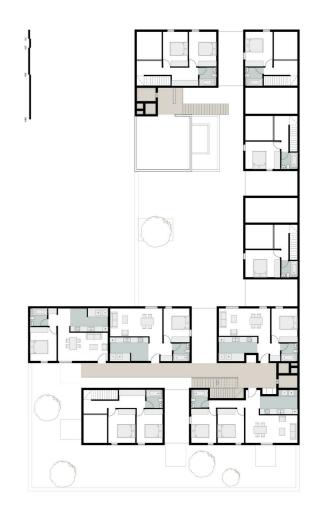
Zonas Húmedas, Segunda Planta Alta Fuente: Autores, 2022
